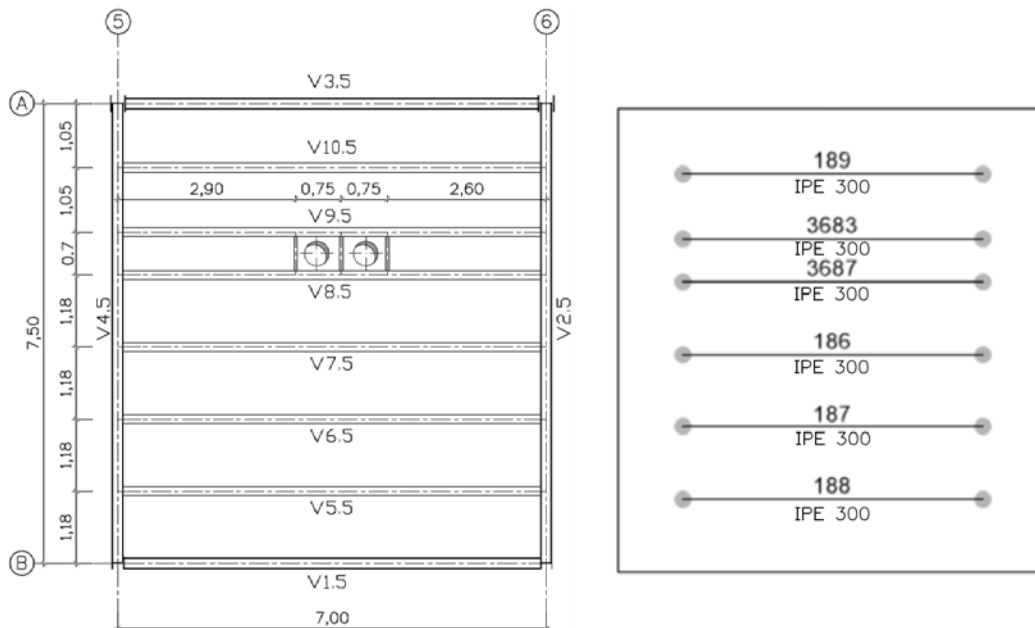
Planta com a Identificação das Vigas Interiores do Piso 5
